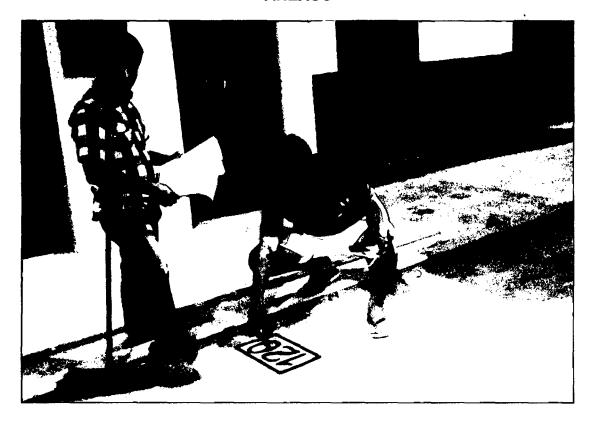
Muestreo del pavimento en la avenida Pakamuros.
